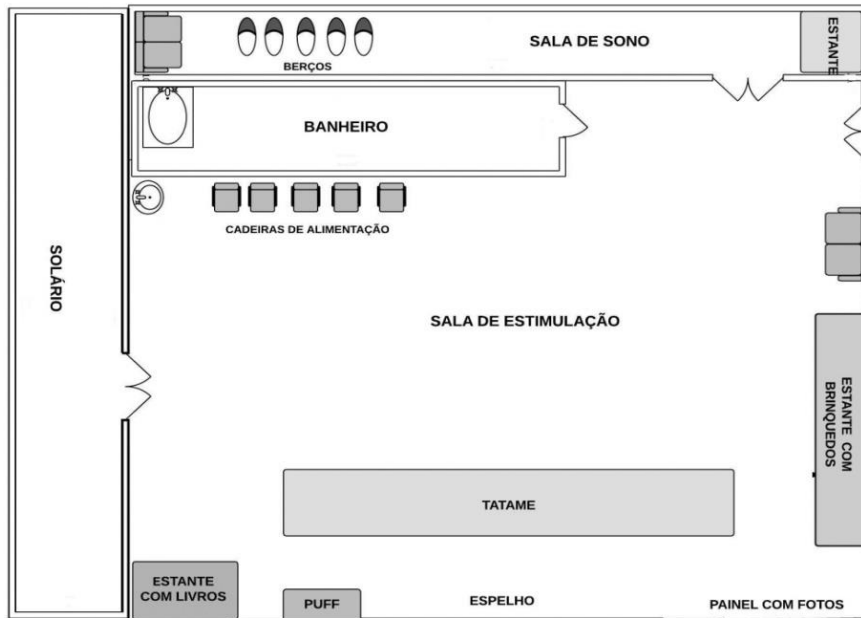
Planta baixa do berçário. Fonte: Elaborado pela autora.
